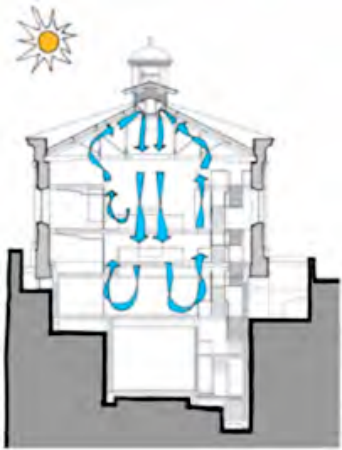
Ventilazione indotta dal sistema di raffreddamento.
